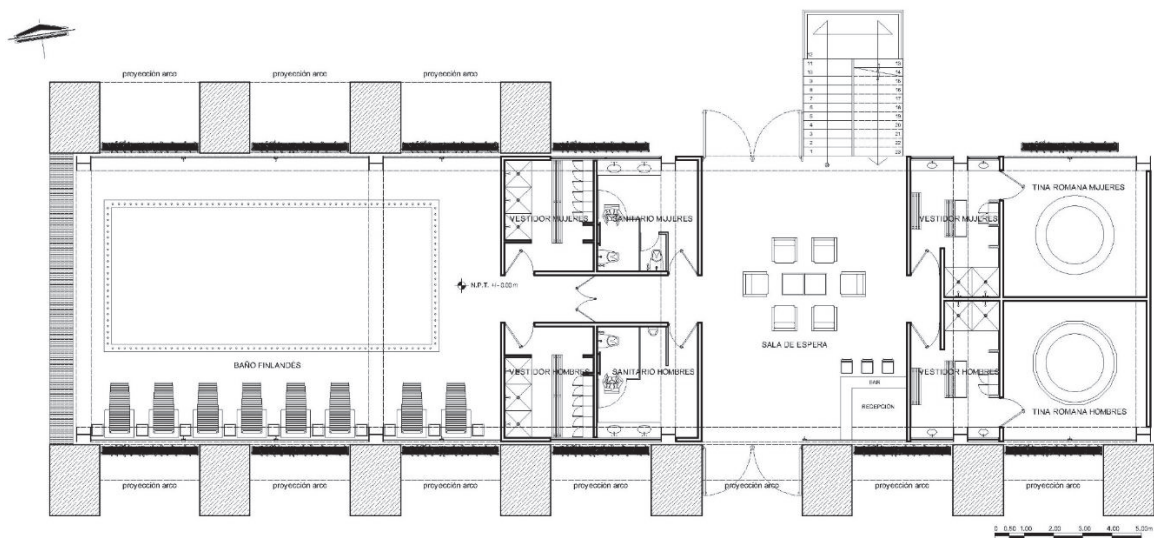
Planta baja arquitectónica para el nuevo uso propuesto para el trapiche convertido en spa.
